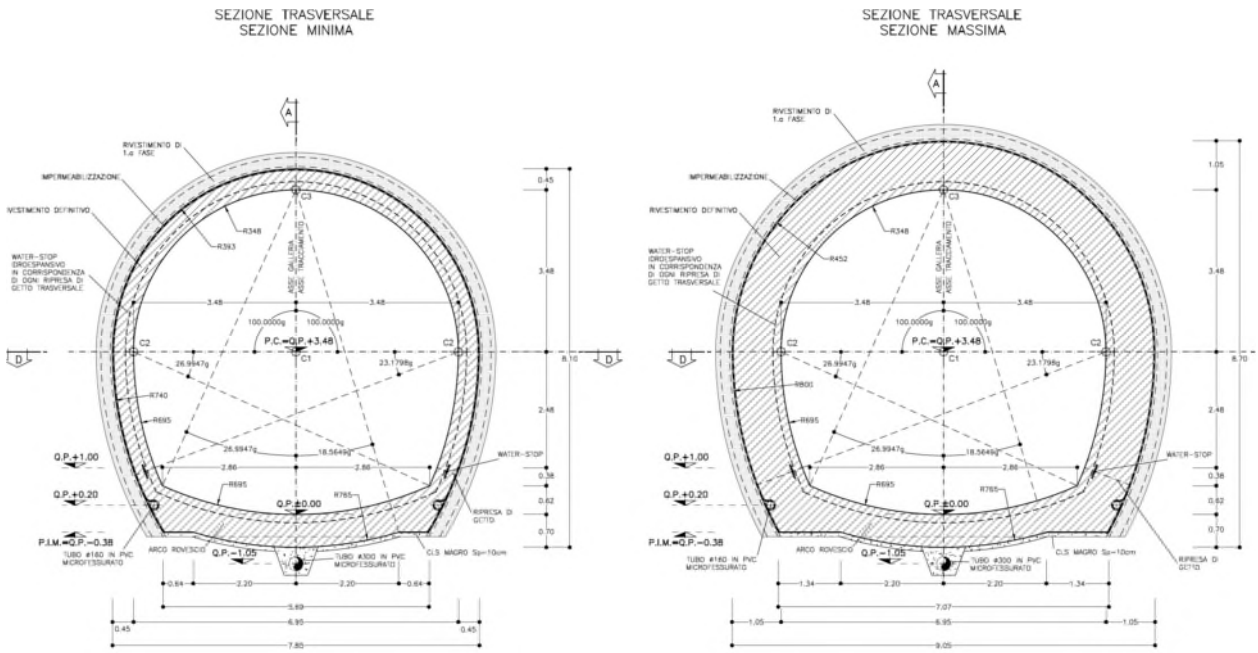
Sezione Tipo B2V – Carpenteria – Sezioni
